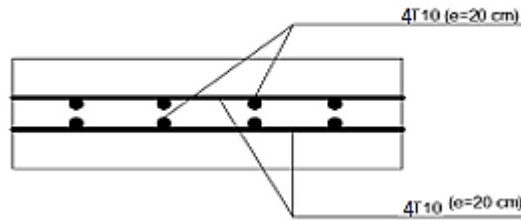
Dessin de ferrailage du voile périphérique pour 1ml.
